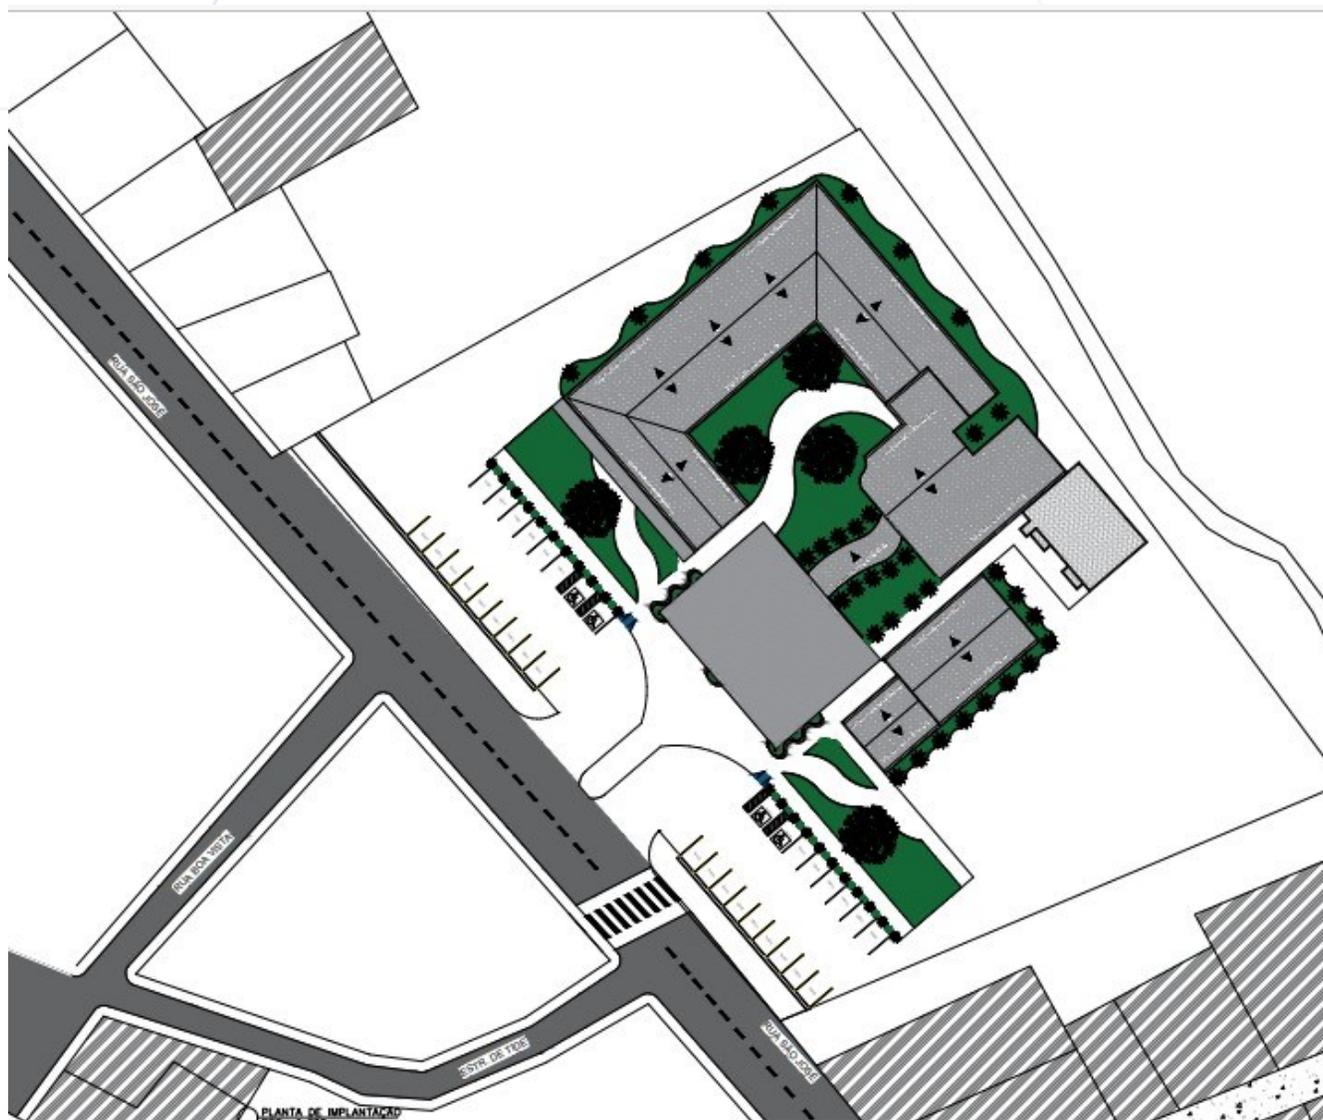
Planta de Implantação. Fonte: pelo autor (2023).
